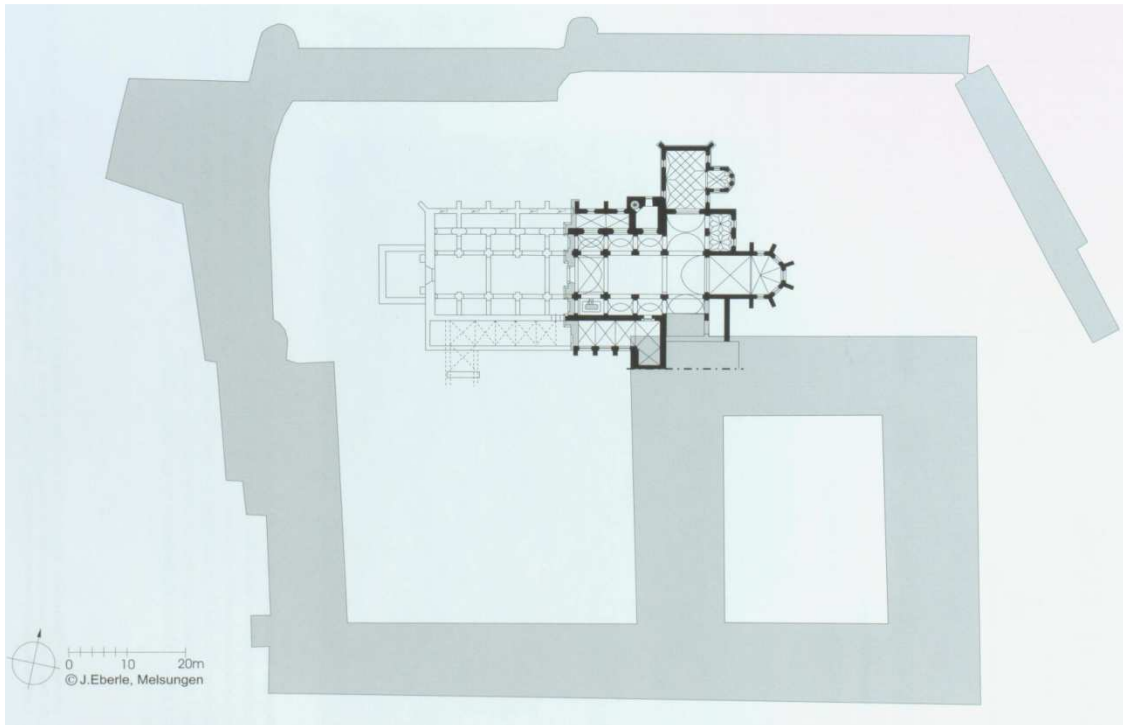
Stift Viktring, Grundriss, Jürgen Eberle
